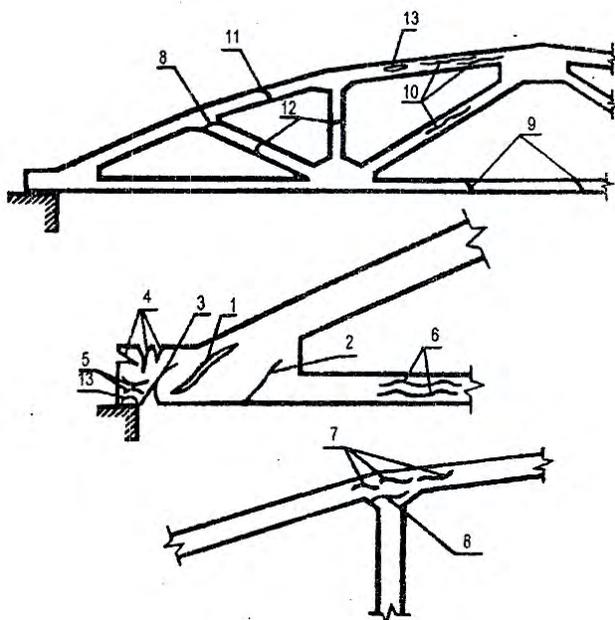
Причины трещинообразования в стропильной раскосной ферме:
